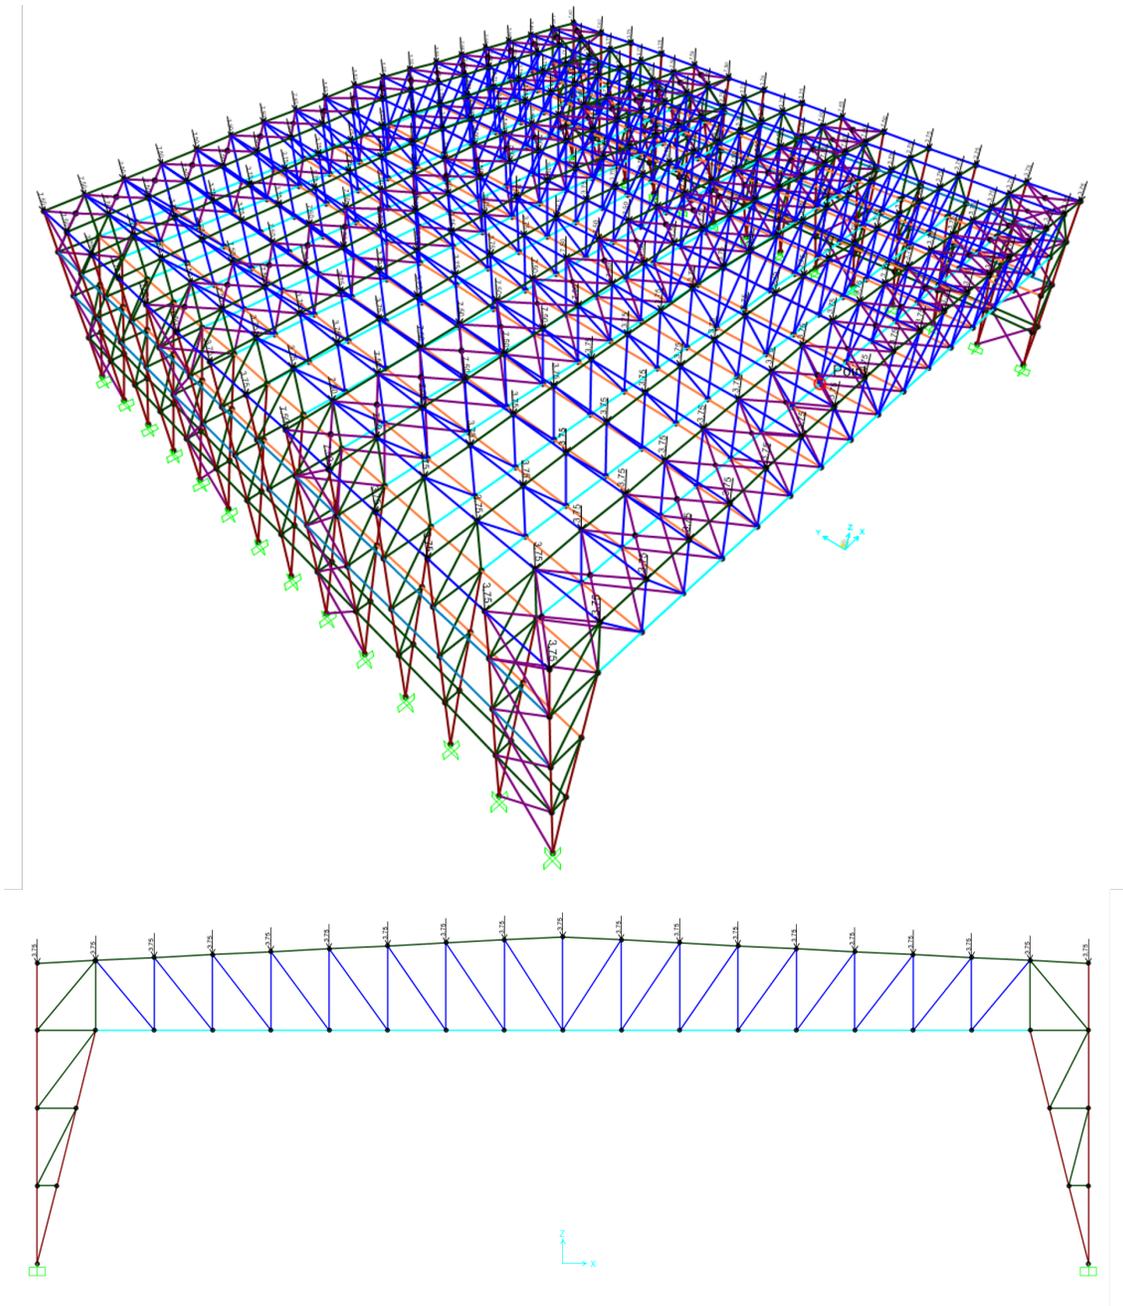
Carga de peso propio sobre la estructura 3D y el pórtico tipo. Elaboración propia.
